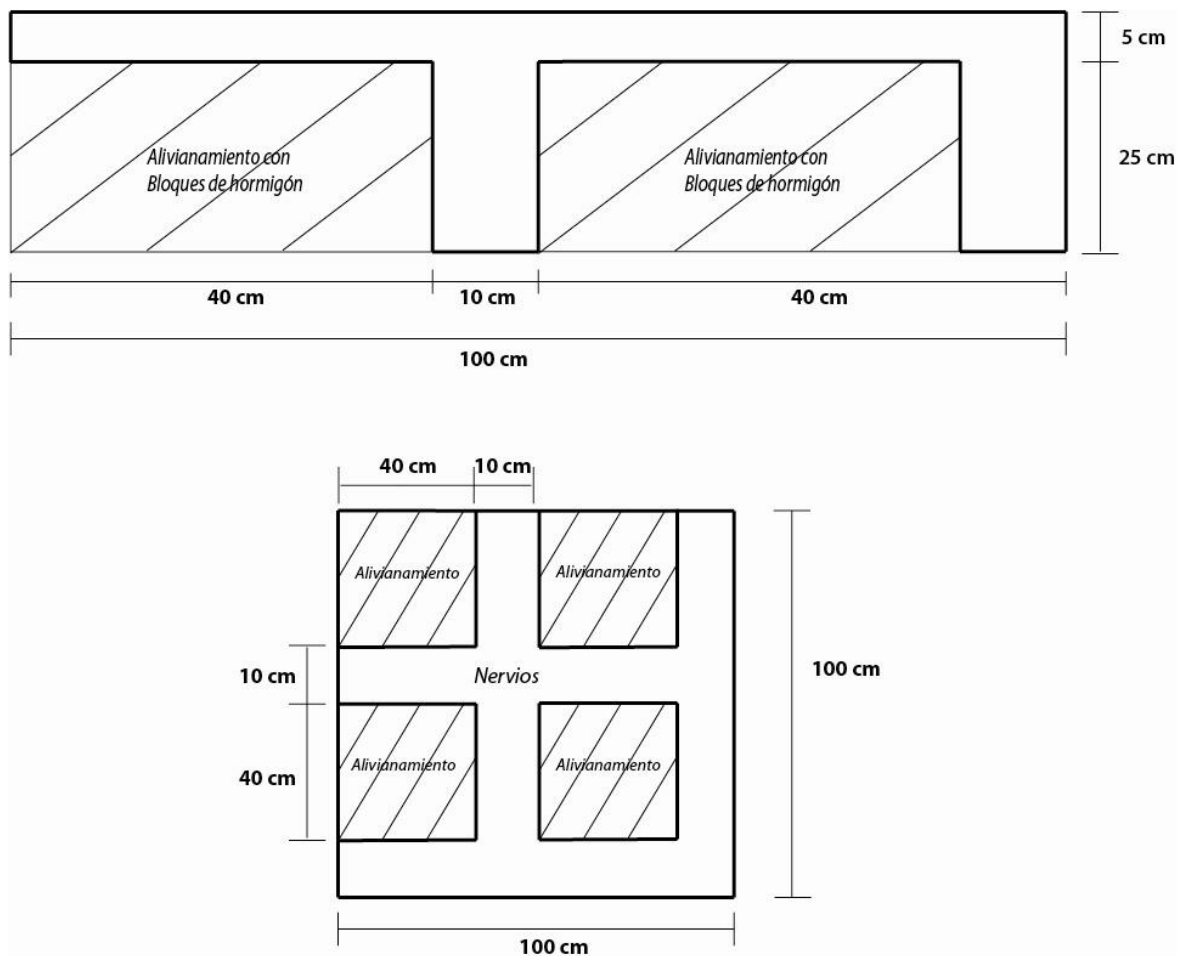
Vista en elevación (arriba) y en planta (abajo) de un  $m^2$  de losa.
